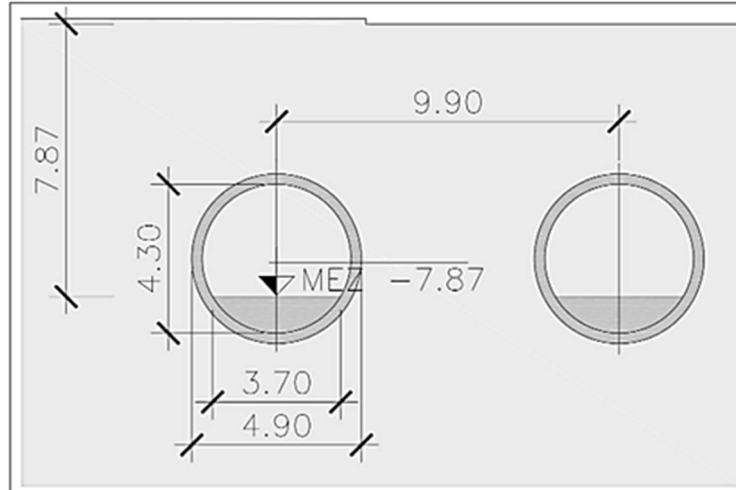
Galerías de conexión de accesos satelitales a estaciones mediante túneles independientes construidos con sistema Liner
